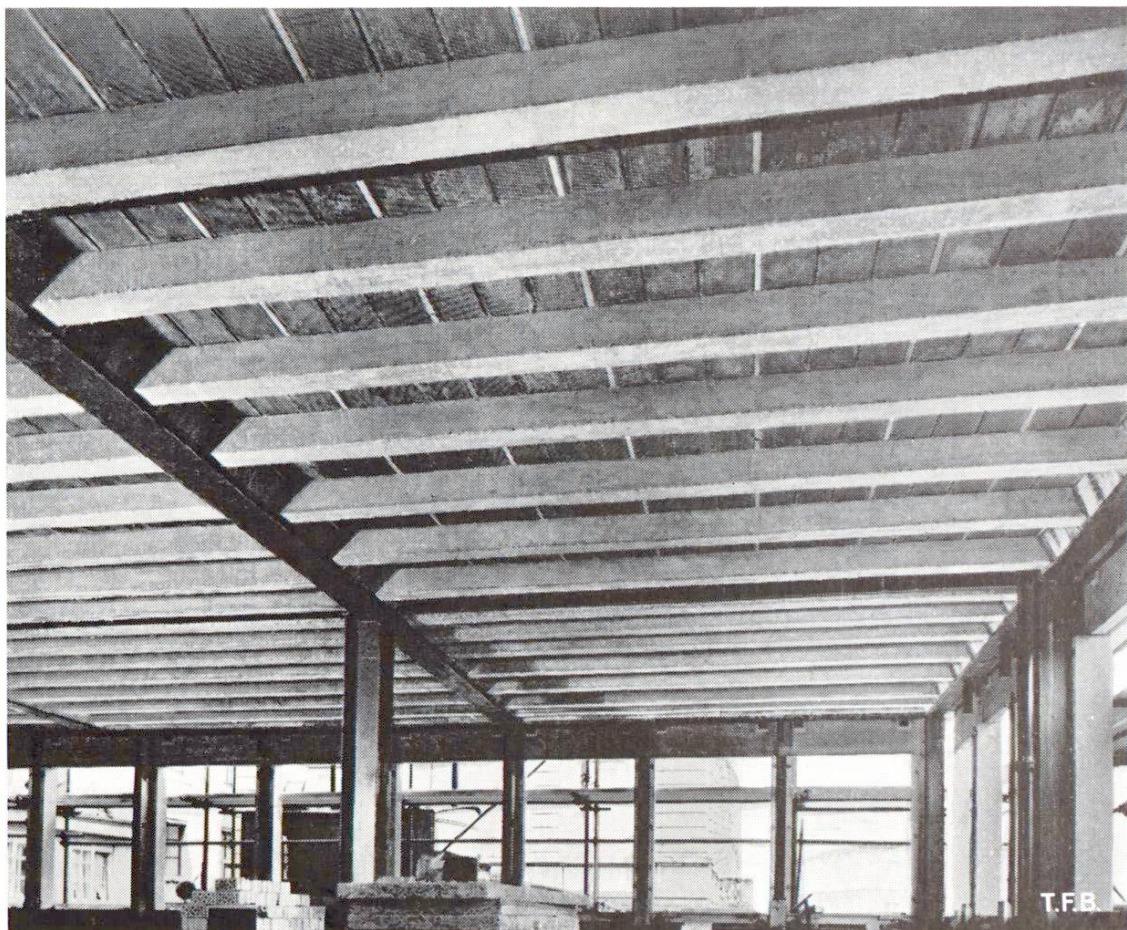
Plancher constitué par des poutres préfabriquées en béton précontraint, avec des hourdis en terre cuite et une légère dalle en béton. Charge utile 500 kg/m². Portée 4,5 – 7,5 m
